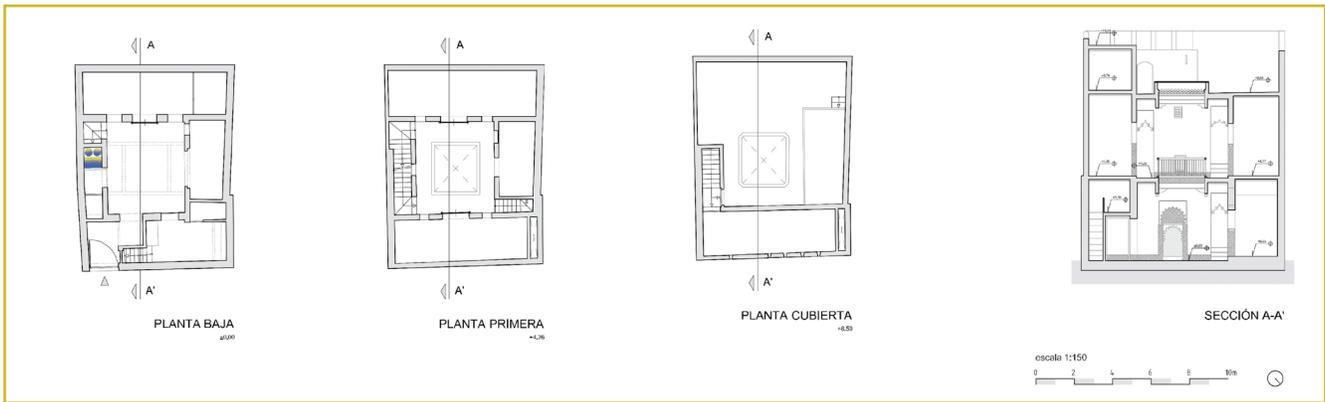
Plantas y corte de casa dar Saka (fuente: Los autores).
